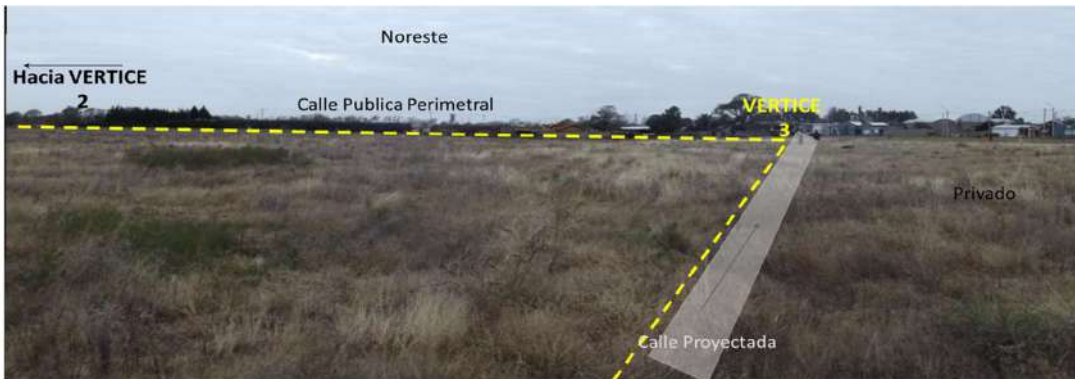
Vista intersección calles Publica perimetral limite Noreste y la continuación proyectada de la calle Paso de los Andes
